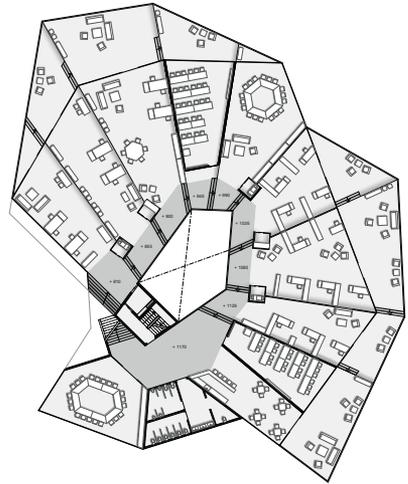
Grundriss +810 bis +1170 cm
